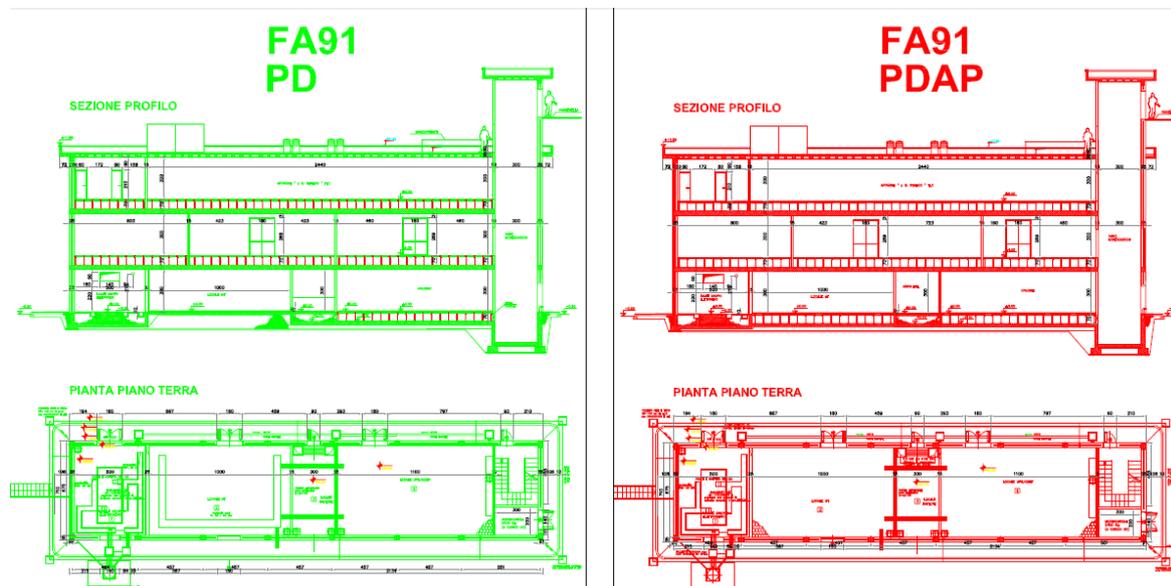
A sinistra in verde planimetria e sezione della versione PD a destra in rosso il PDAP
